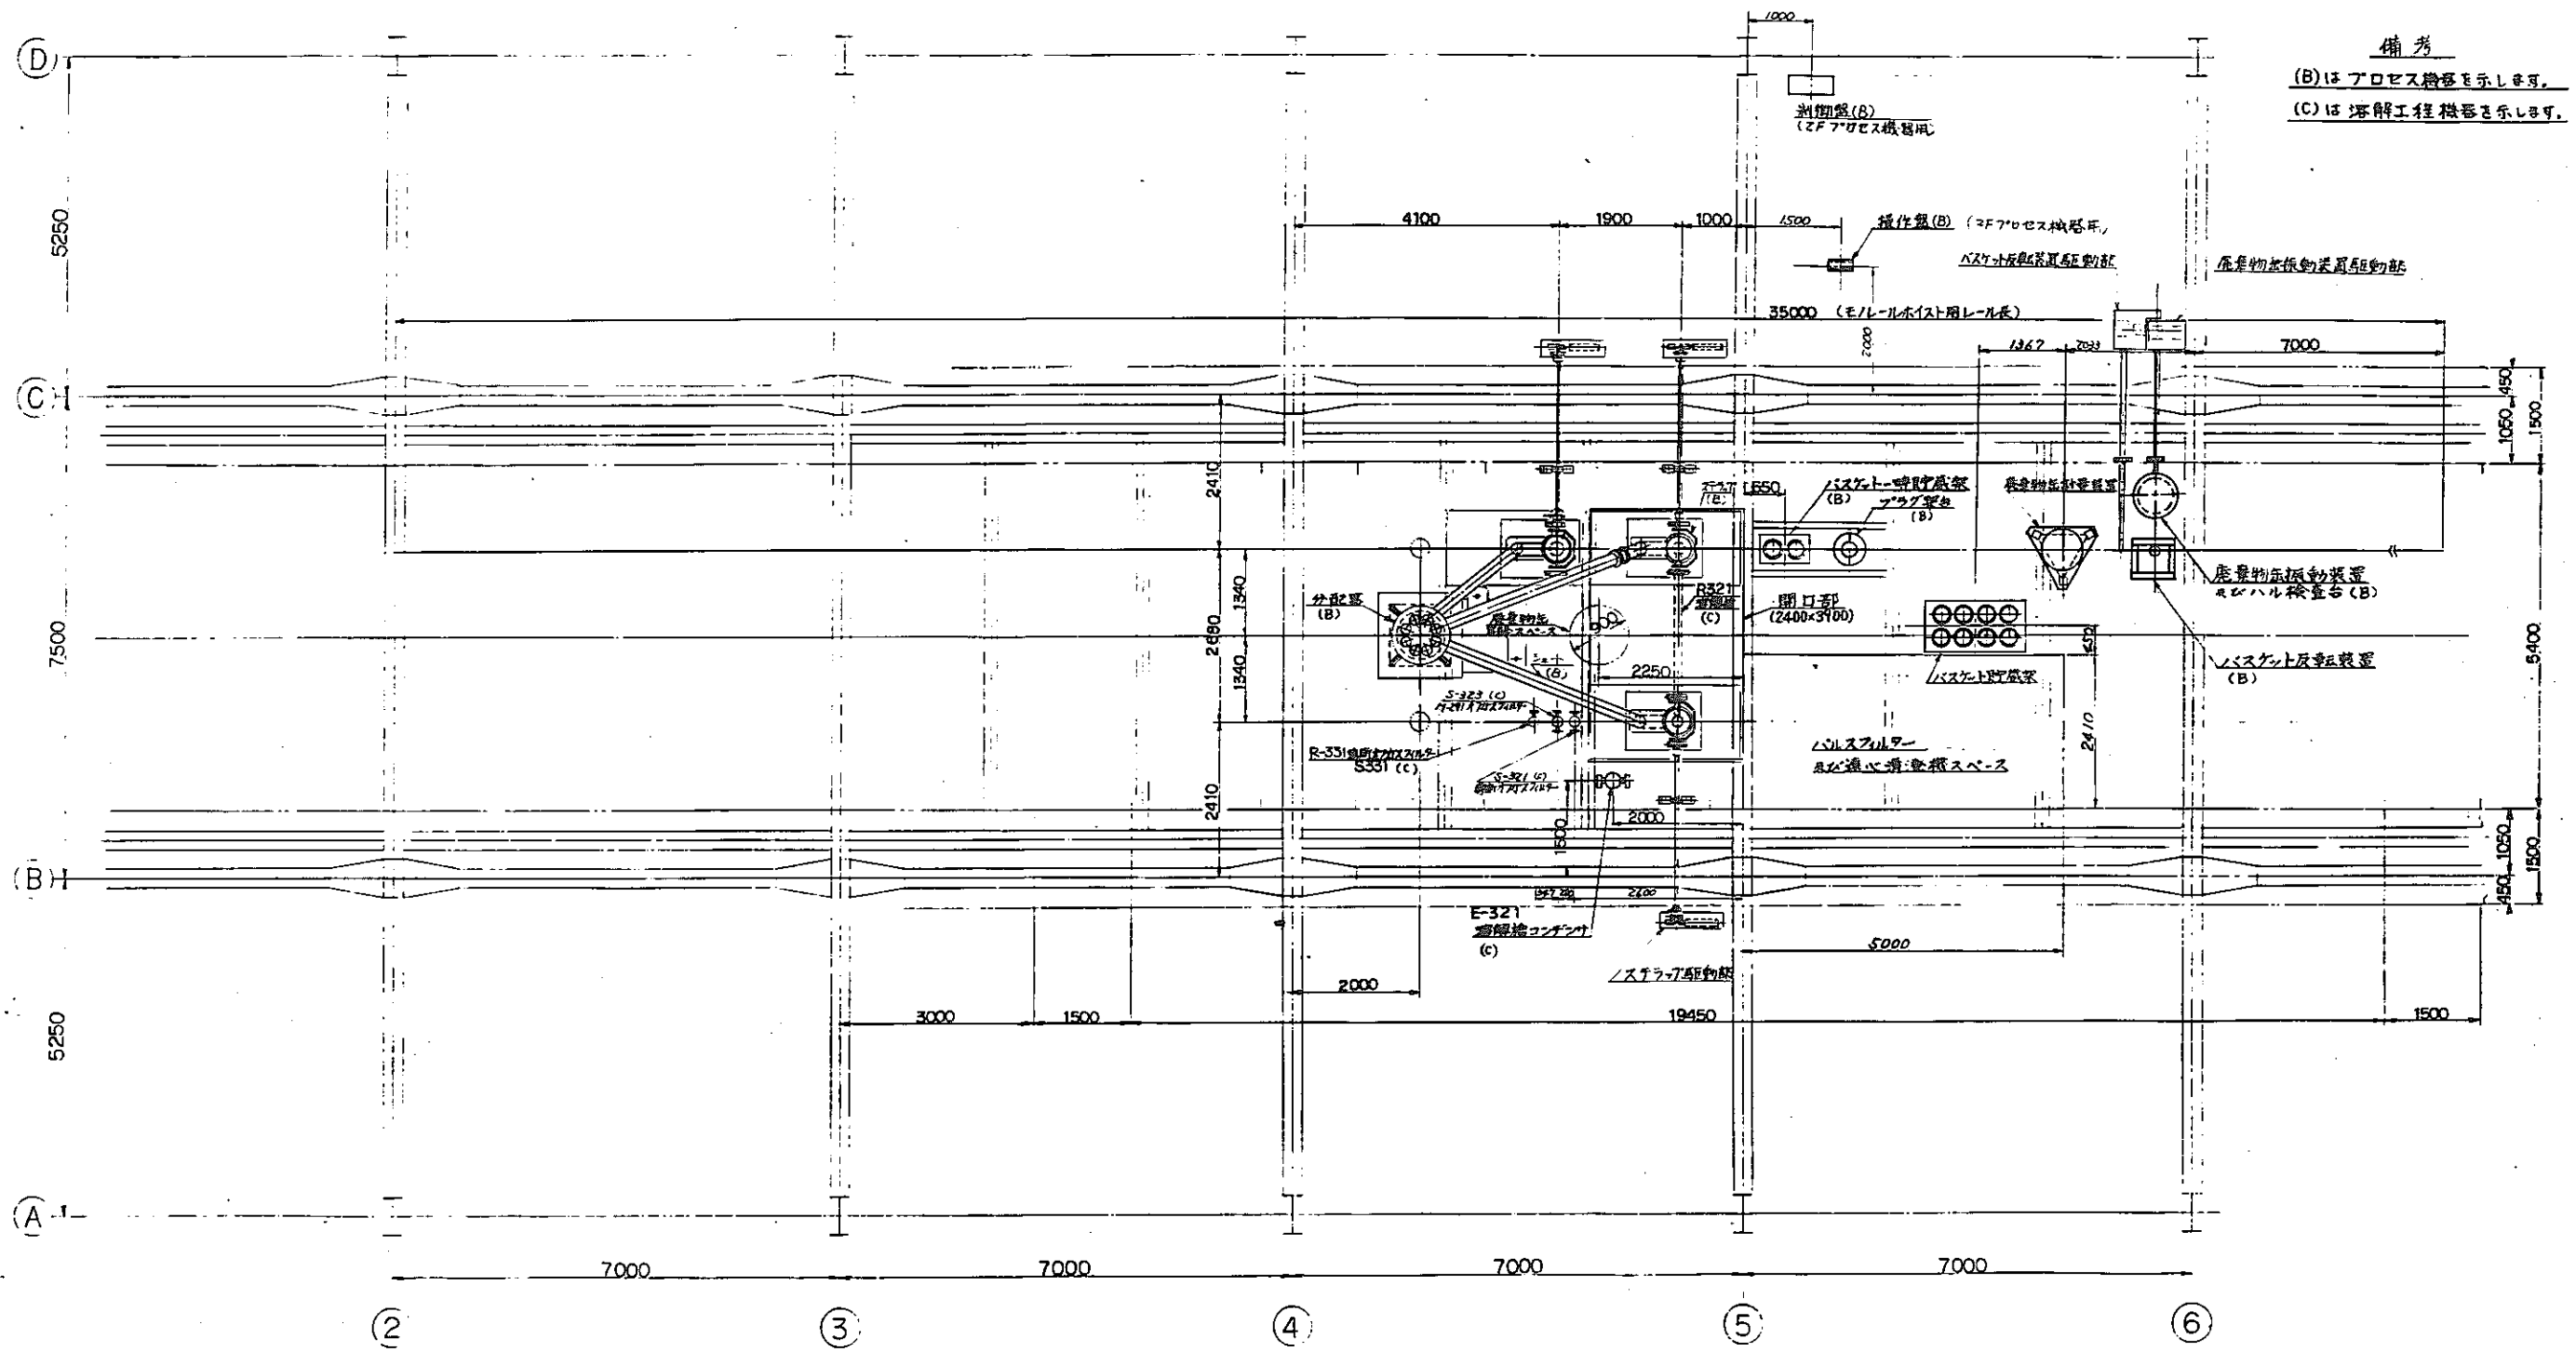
プロセス機器モックアップ設計・製作 機器配置図 (2FL平面)
